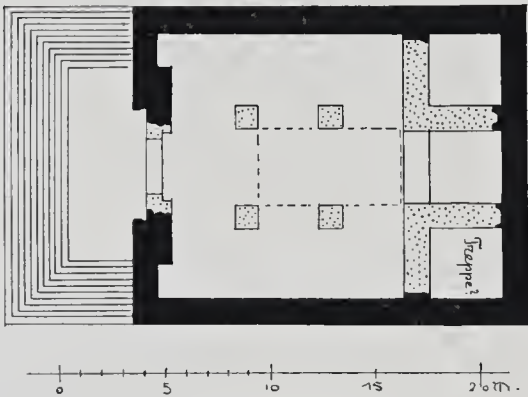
Rekonstruktion des Grundrisses.
